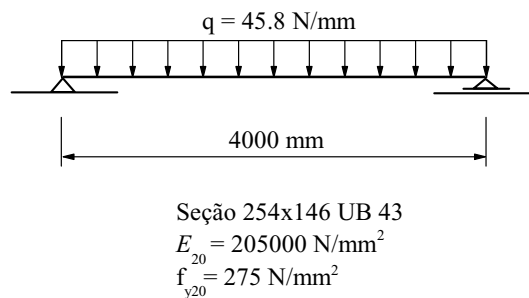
Exemplo 3: Viga bi-apoiada com carregamento distribuído
